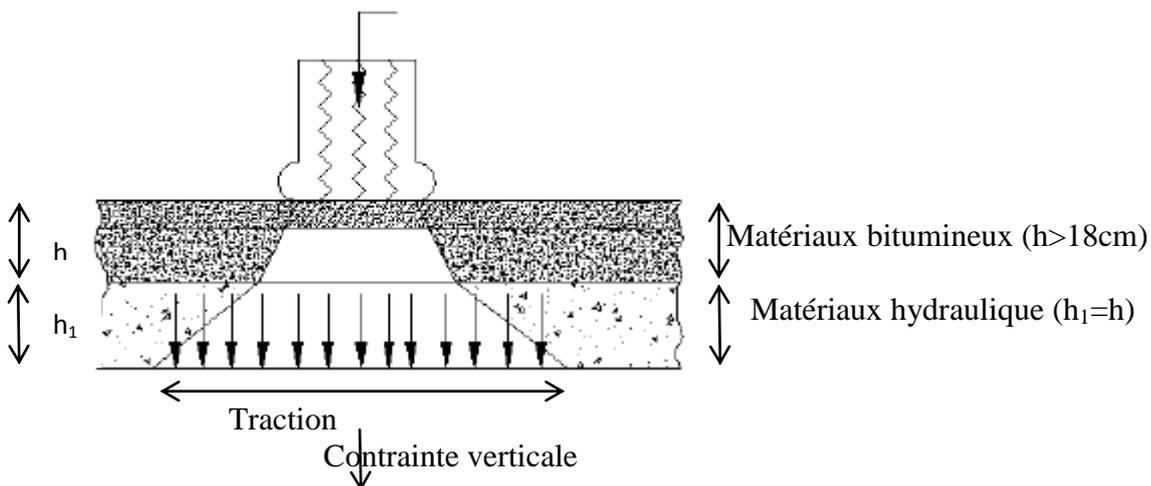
Mode de fonctionnement d'une chaussée à structure mixte. SETRA-LCPC 1994
